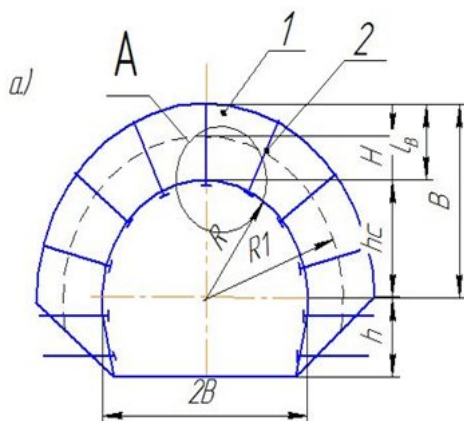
Схема формирования несущей конструкции в нарушенных породах
